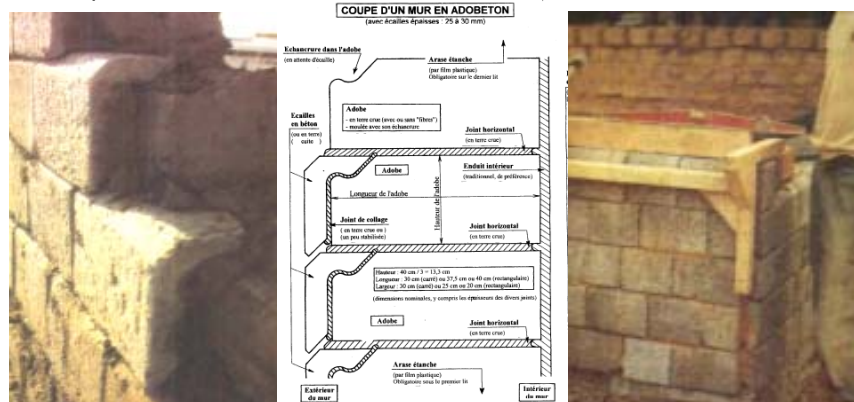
Construção de parede em “Adobeton” e desenho técnico da mesma
